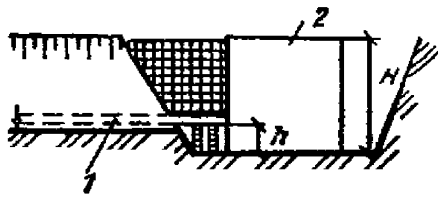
Примыкание трубопровода (1) к сооружению (2)
